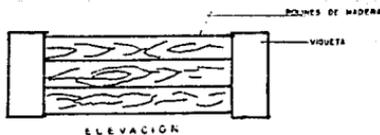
ATAGUIA DE MADERA Y ACERO
